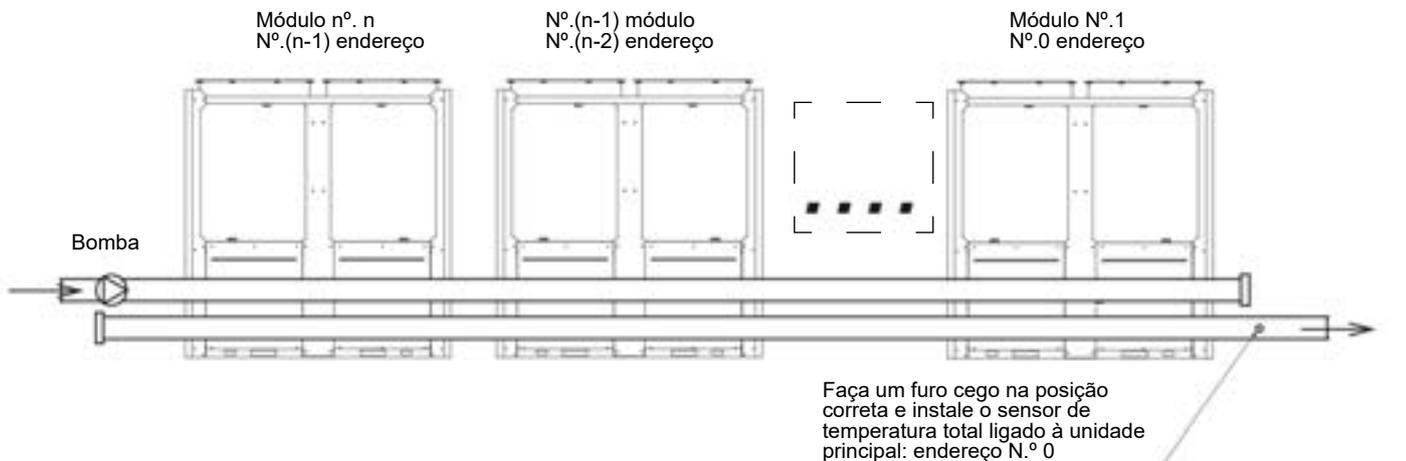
Instalação de vários módulos (não mais que 16 módulos)
